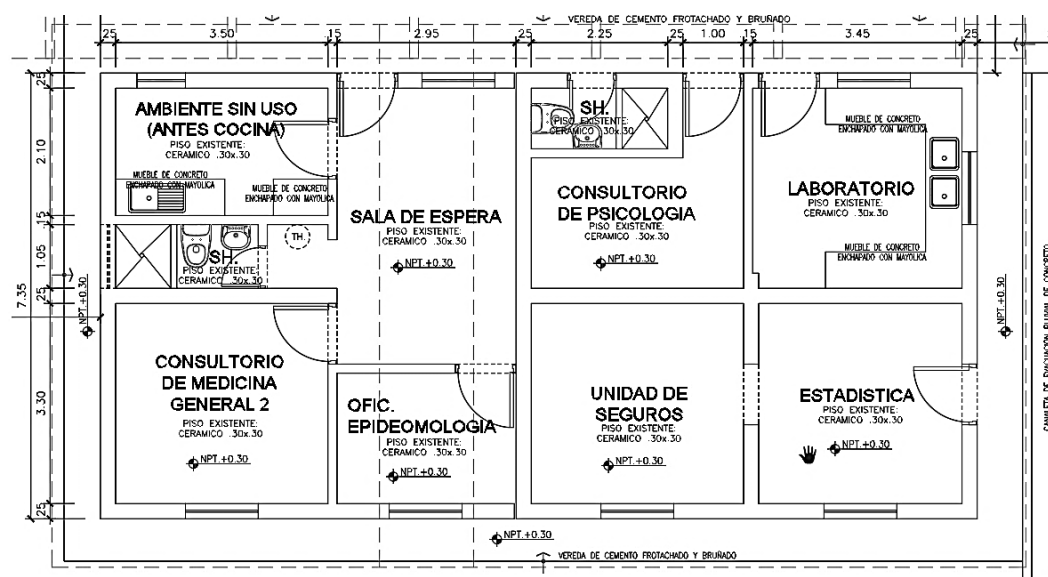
PLANO DE PLANTA BLOQUE 02 – PAIMAS I-4
